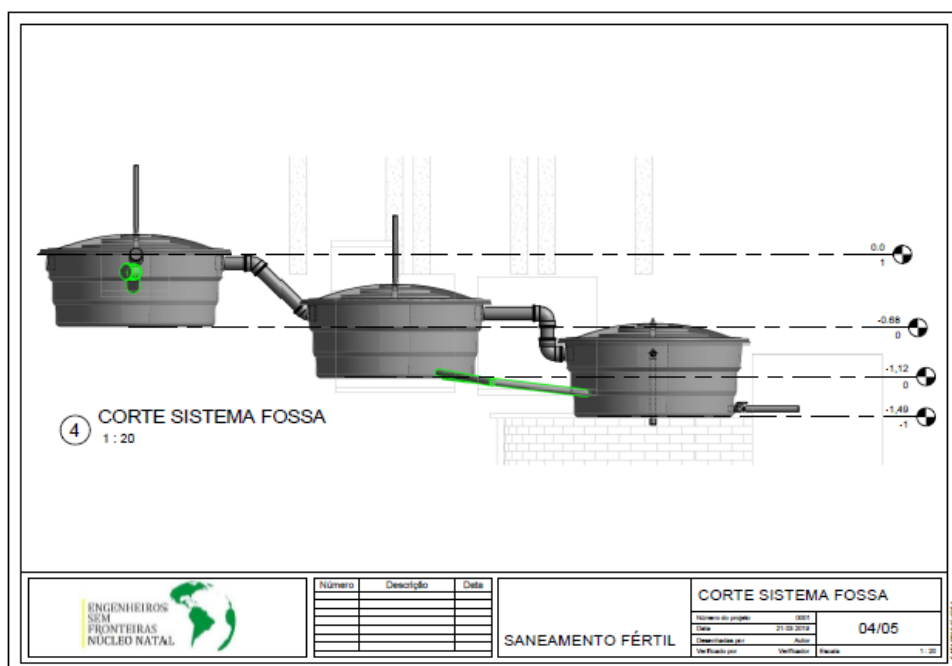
Prancha do projeto integrado do sistema de tratamento de esgoto – Corte do Sistema Fossa
